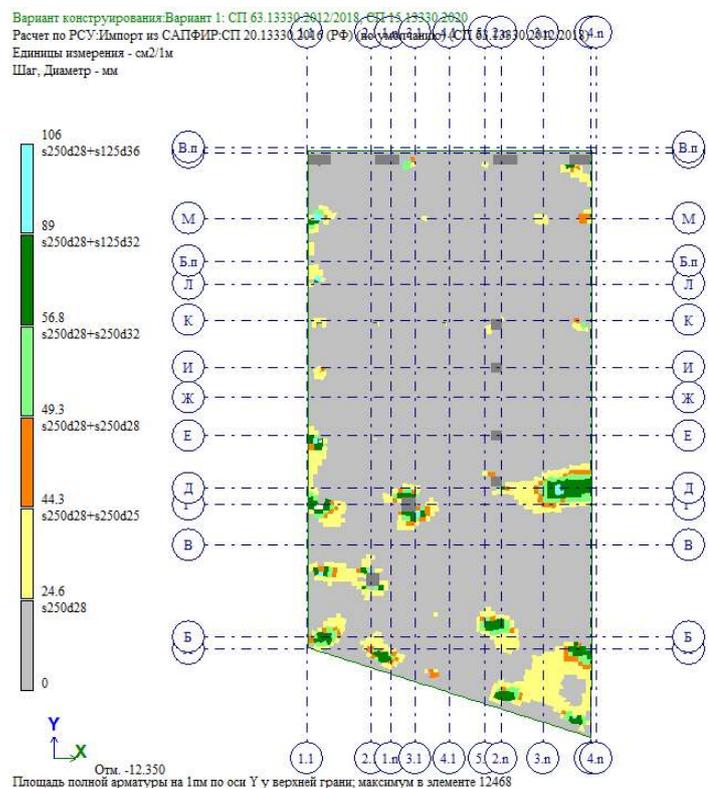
Армирование плиты по оси Y у верхней грани (на 1 м.п.)
